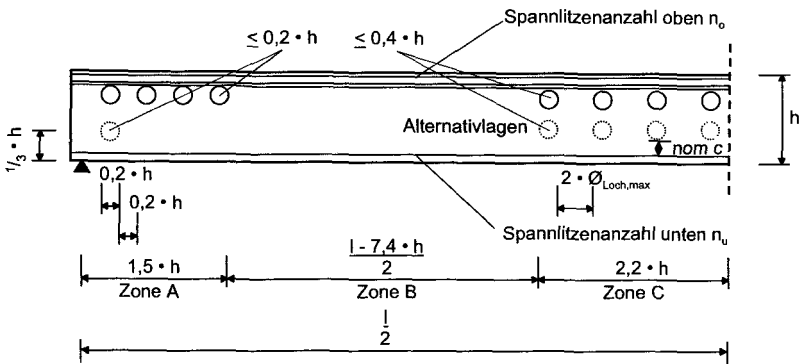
Bezeichnungen für Tabelle 12.29 bei Bindern mit T-Querschnitt
